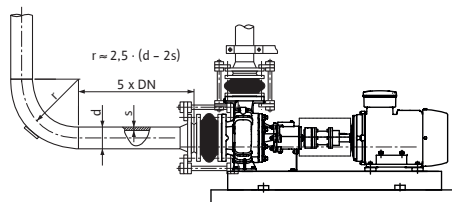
Подсоединение насоса без создания механических напряжений, участок выравнивания потока перед и за насосом
